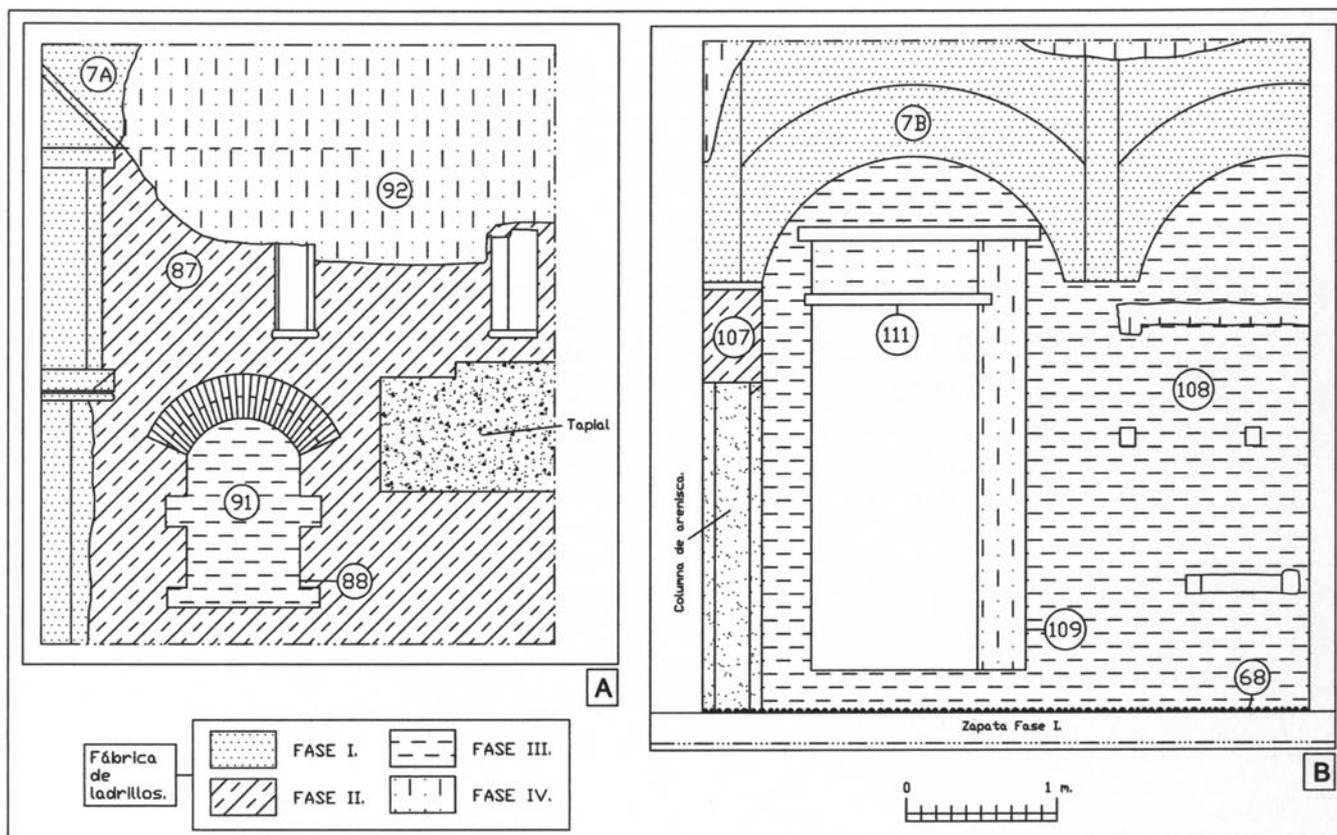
A: Paramento fachada oeste (nº 7A). Planta baja. Alzado interior. Análisis estratigráfico con diferenciación de fases constructivas. B: Paramento fachada oeste (nº 7B). Planta baja. Alzado interior. Análisis estratigráfico con diferenciación de fases constructivas.
